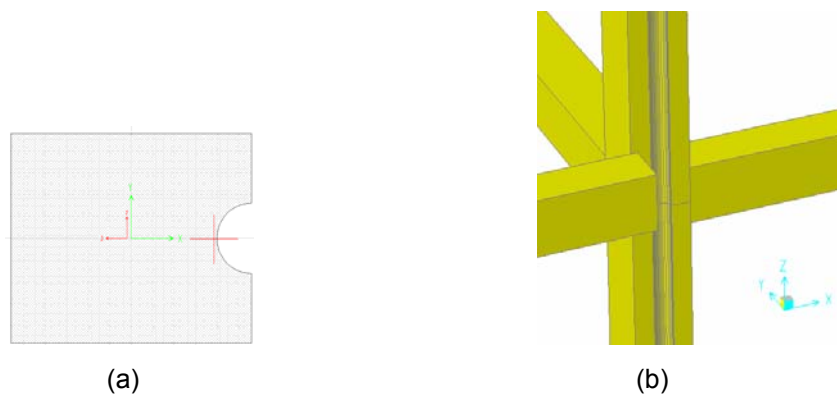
Ejemplo de la incorporación de una sección con una tubería embebida longitudinalmente (a) figura de la sección transversal creada en Section Designer y (b) figura en SAP-2000.
